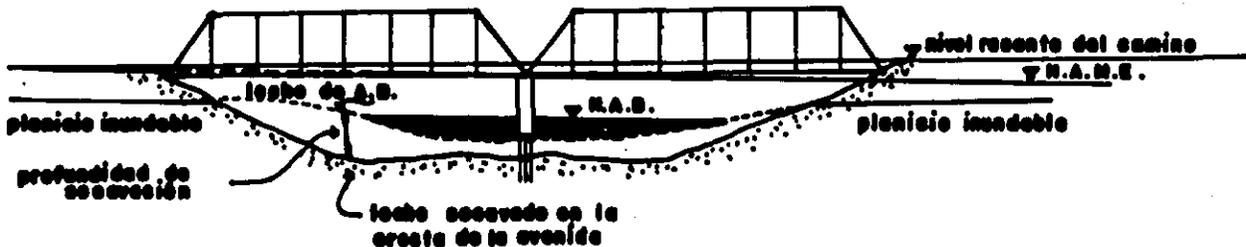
Ejemplo mostrando la excavación general en el estrechamiento resultante del paso de una avenida, medida por sondas desde el puente
